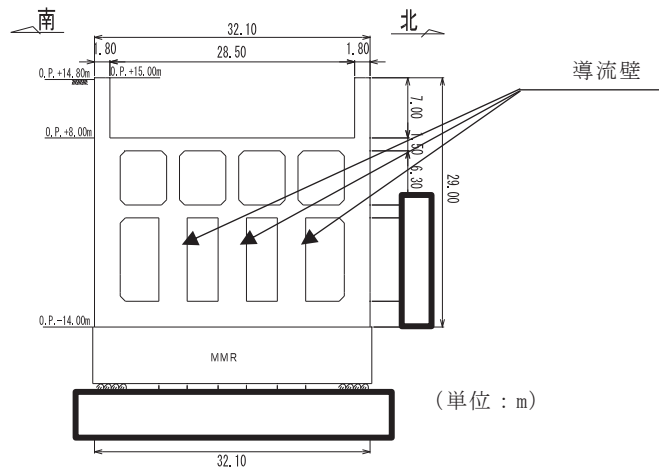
第 3 号機海水ポンプ室断面図 (A-A 断面, 南北 (スクリーンエリア))
